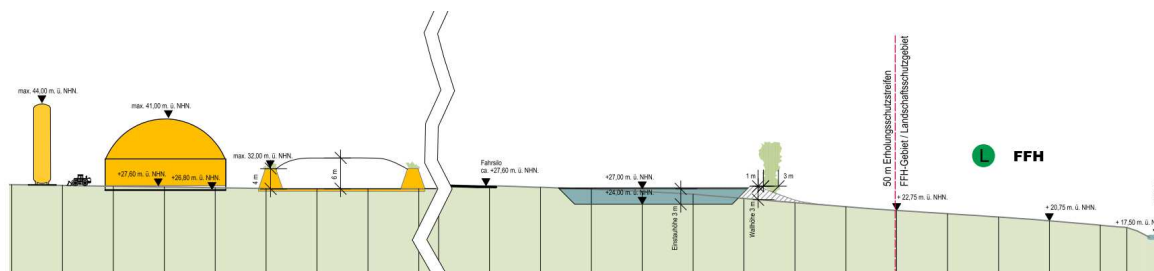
Geländeschema mit Darstellung der Höhe der baulichen Anlagen
